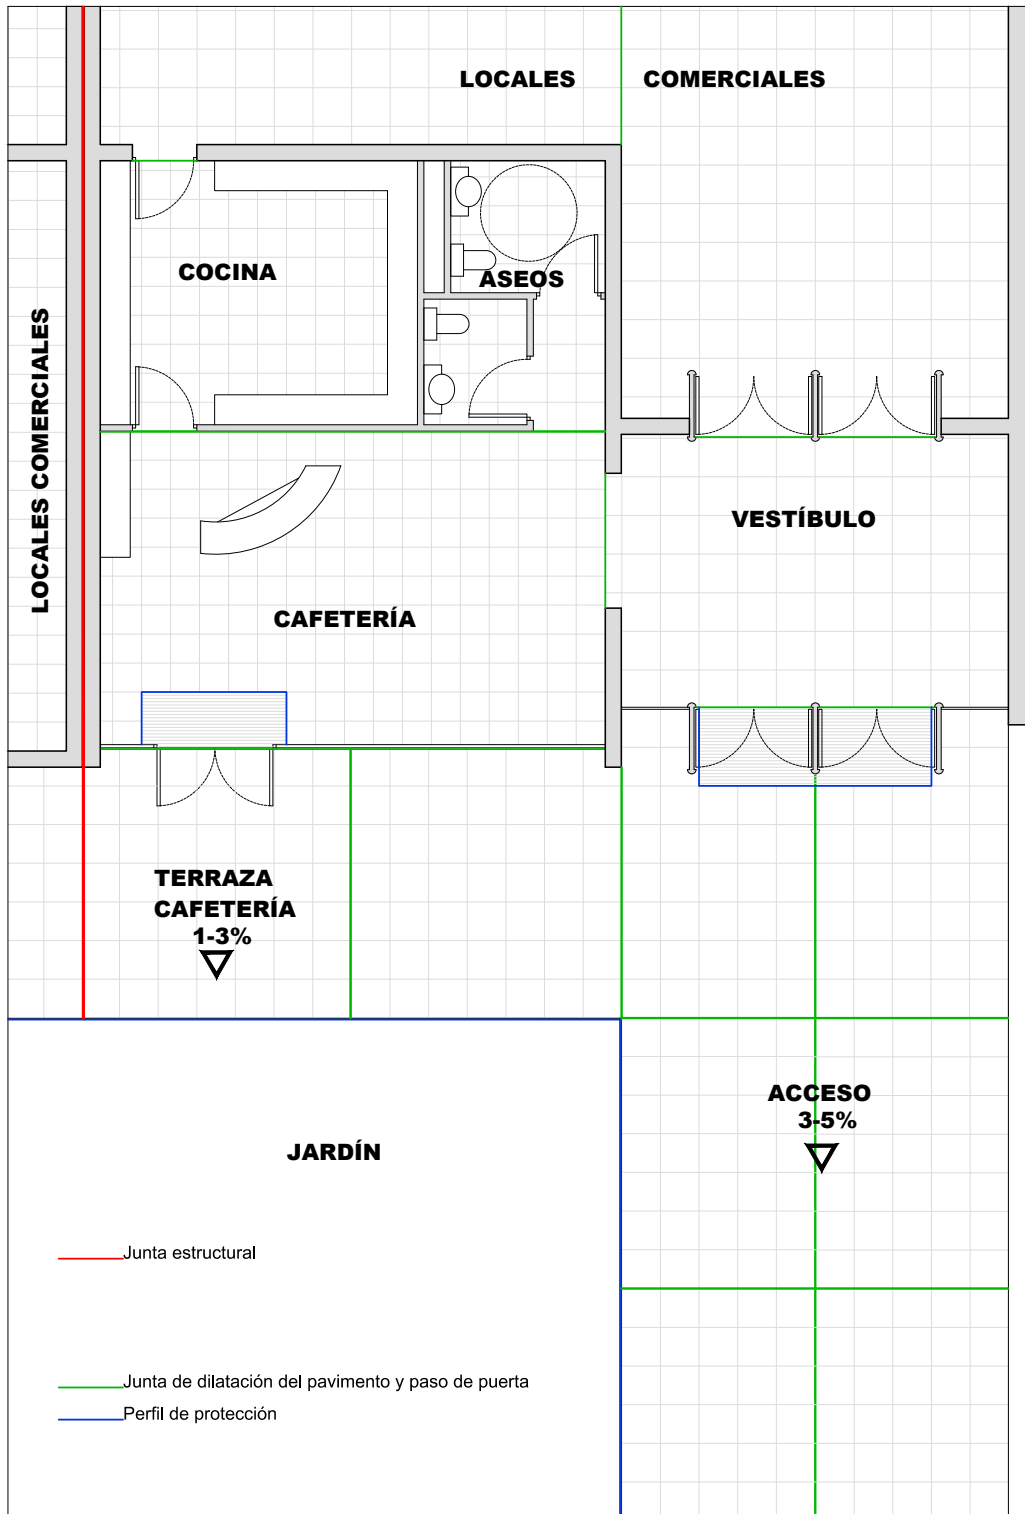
Juntas, perfiles de protección y replanteo del pavimento.
